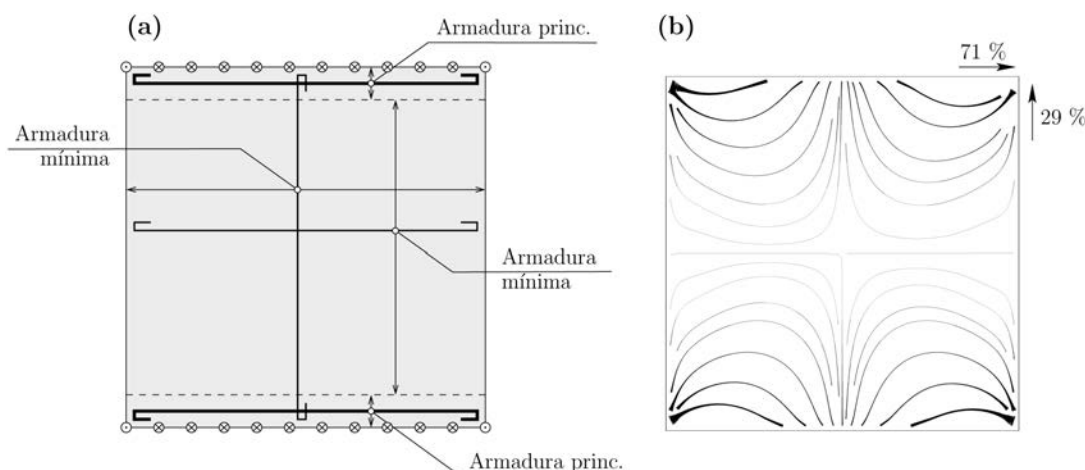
Campo de esfuerzos cortantes en la losa de la figura 9, para zonas con rigideces diferentes (con armadura mínima y principal): (a) losa y esquema de armado; y (b) campo de esfuerzos cortantes.
